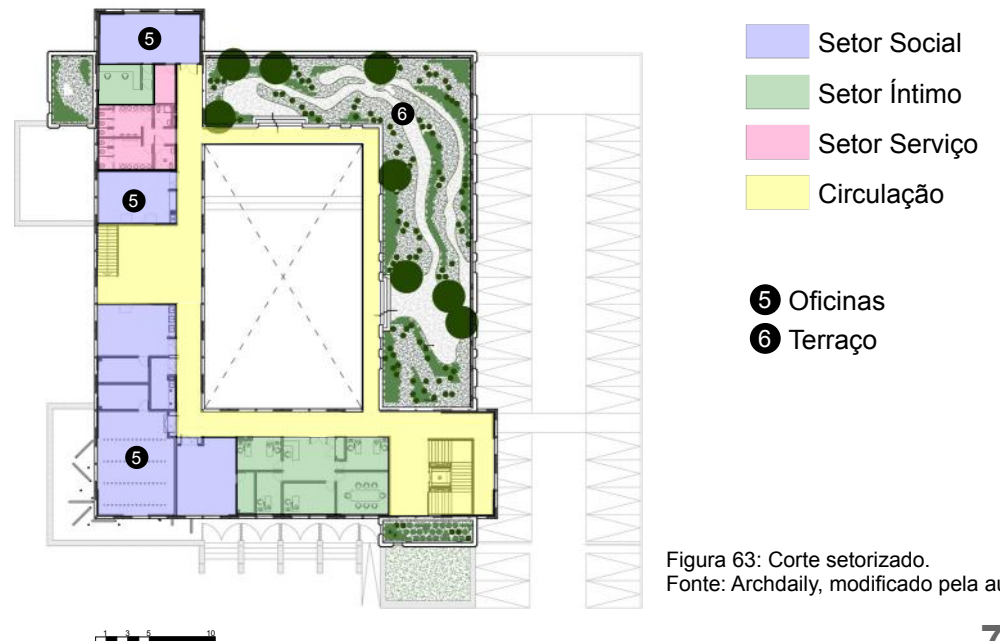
Corte setorizado. Fonte: Archdaily, modificado pela autora.
